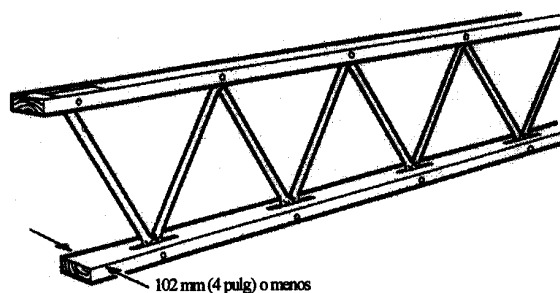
(b) (i) 1 Construcción de viga de varilla con madera.
